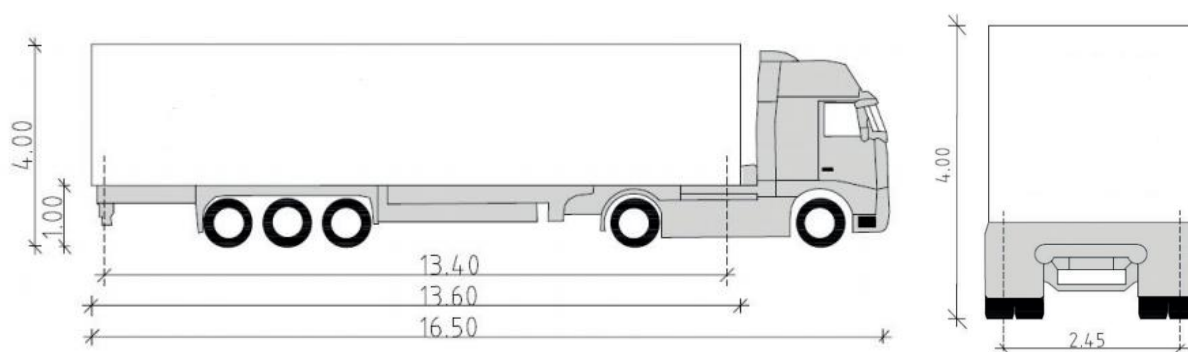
Dimensões do camião lona padrão para transporte dos elementos em painéis pré-fabricados
